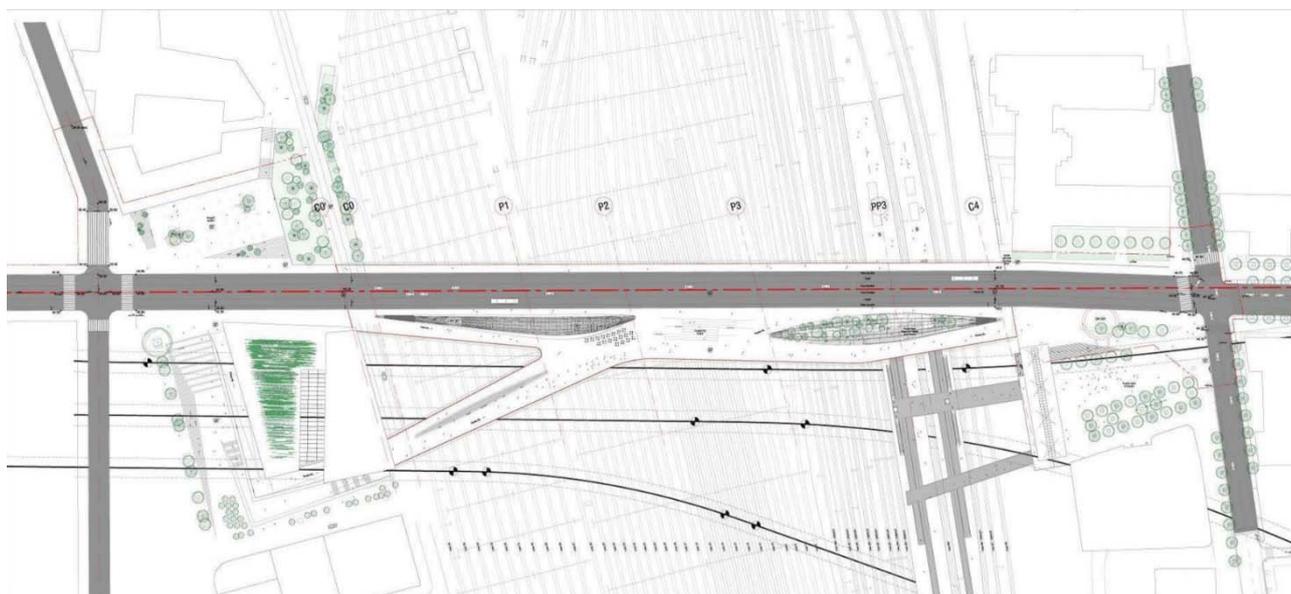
Esquisse du plan masse de l'ouvrage de franchissement (source : dossier)
